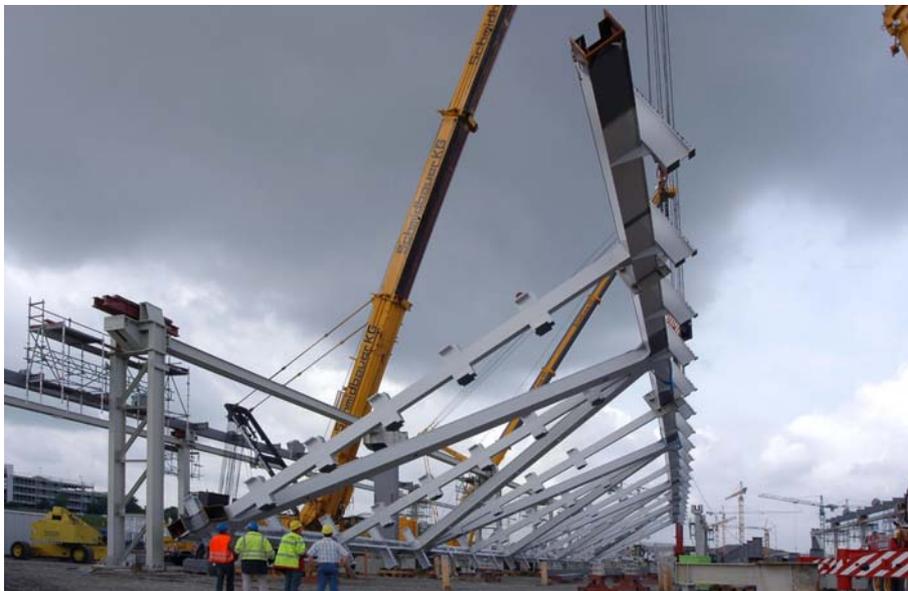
Der Verschub wird in einem kleinen Film präsentiert
